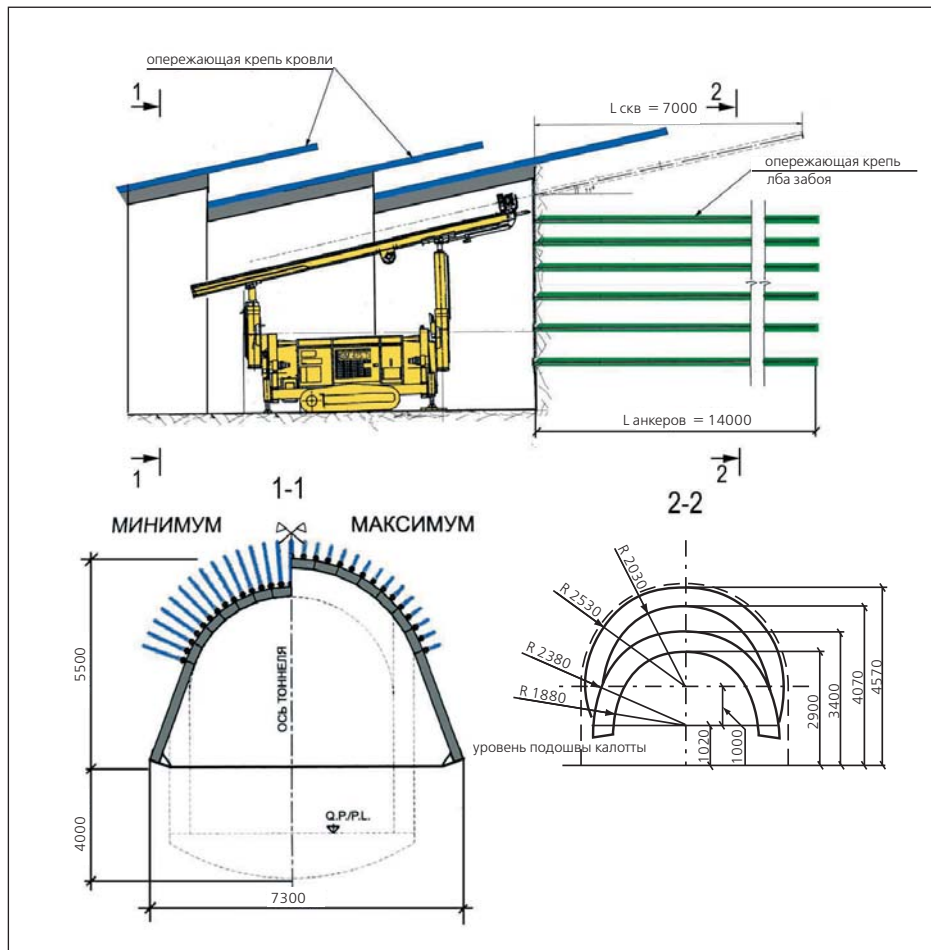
Схема опережающей крепи кровли и лба забоя подходной выработки
